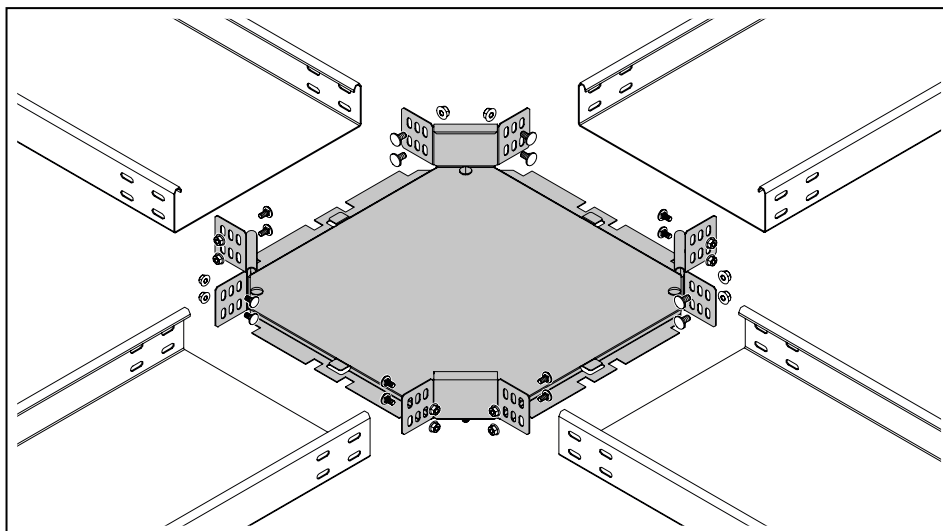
Крестообразное ответвление с угловыми соединителями WKV
